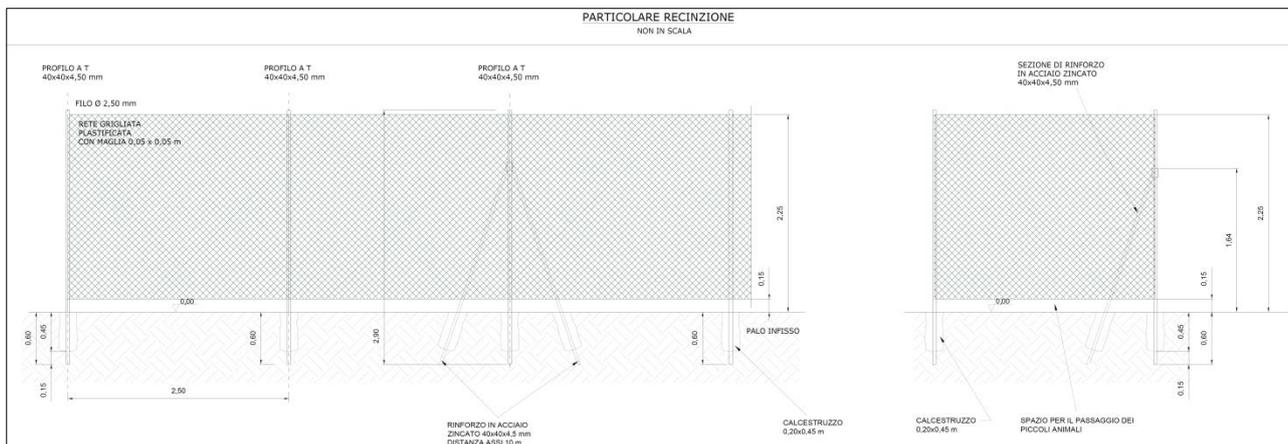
particolare recinzione con rete grigliata plastificata, sollevata di 15 cm dal suolo per il passaggio della piccola fauna.
